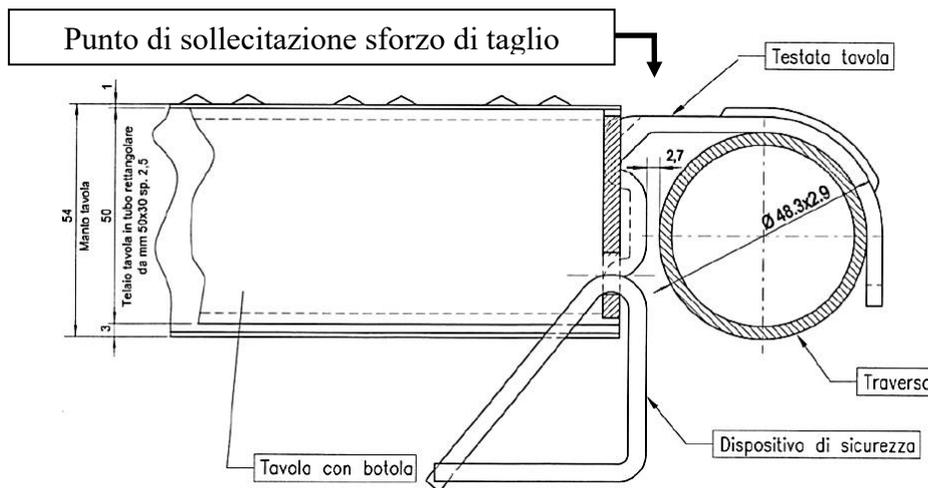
Sezione di collegamento tra ripiano metallico e trasverso
